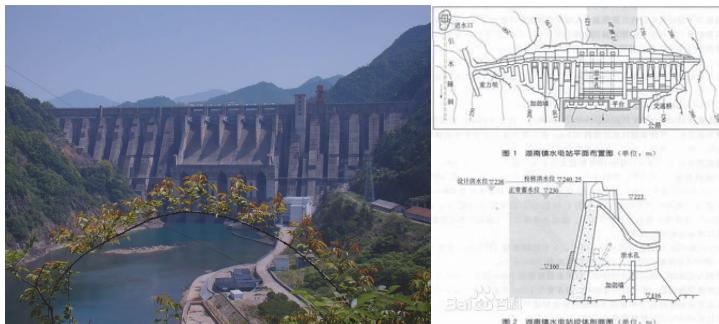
Фото гидроузла Ху Нань Чжэнь и конструкция контрфорсной бетонной плотины
